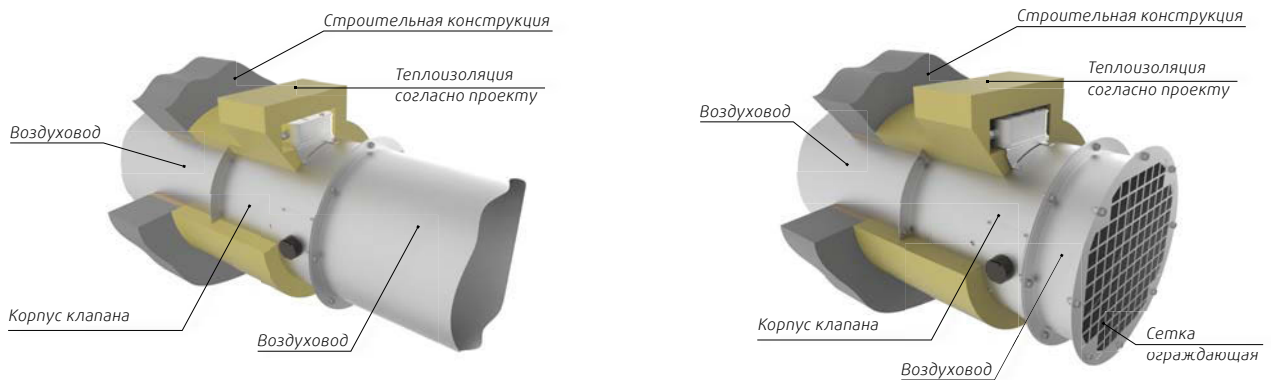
Схема монтажа клапана круглого сечения с возможностью стеновой заделки
